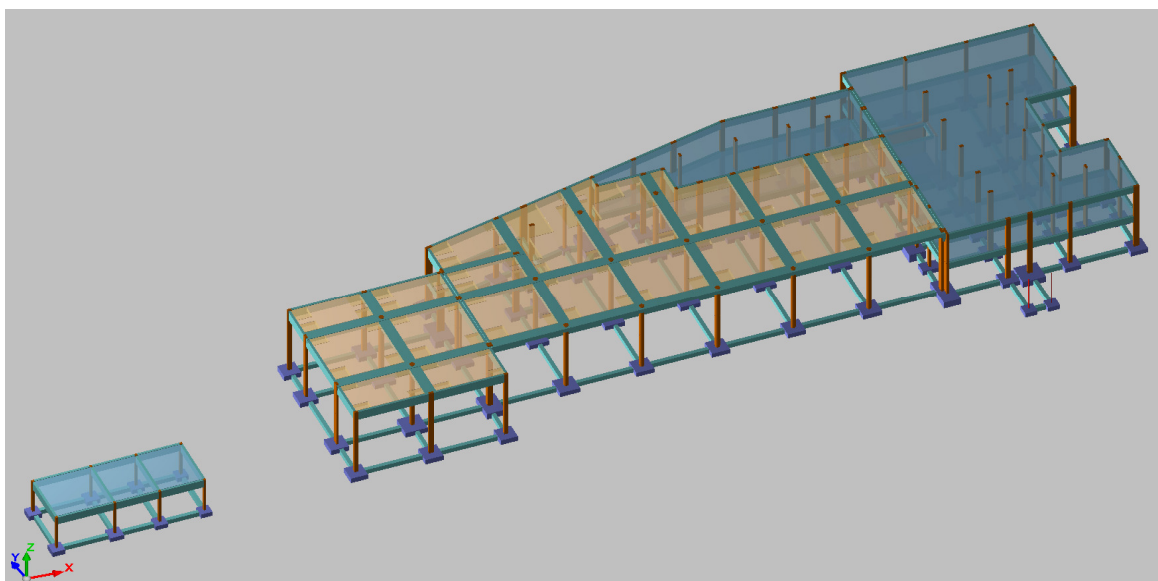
Pórtico em 3D da Lota PXF (Cypecad)
